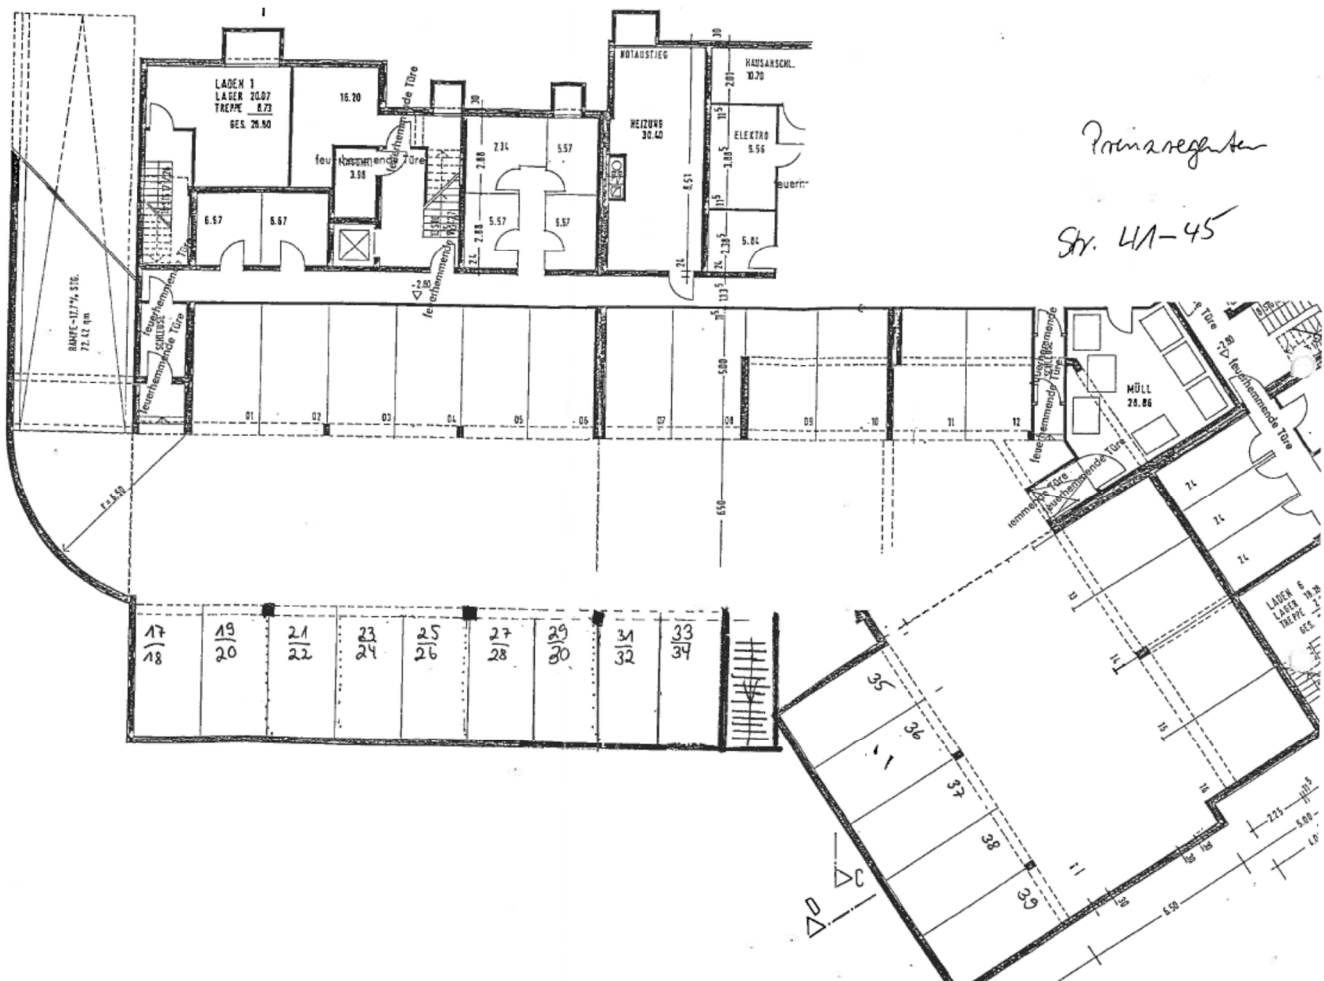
Grundriss- und Stellplatzplan.
